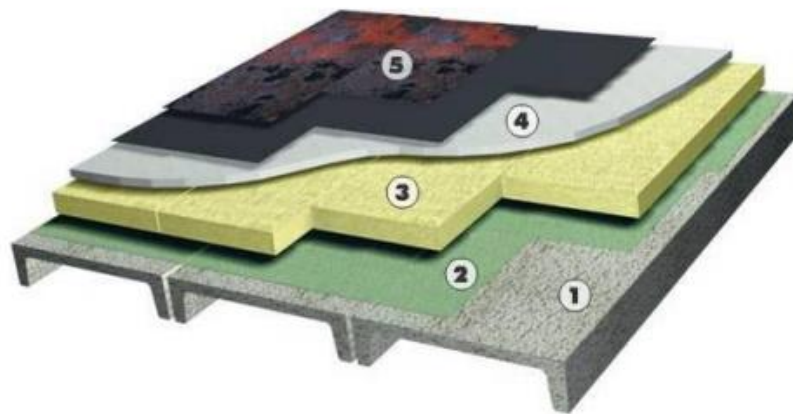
Структура плоскої покрівлі: 1 – плити покриття; 2 – шар пароізоляції; 3 – шар утеплювача; 4 – залізобетонна стяжка; 5 – шар гідроізоляції (рулонної або наплавлюваної)
